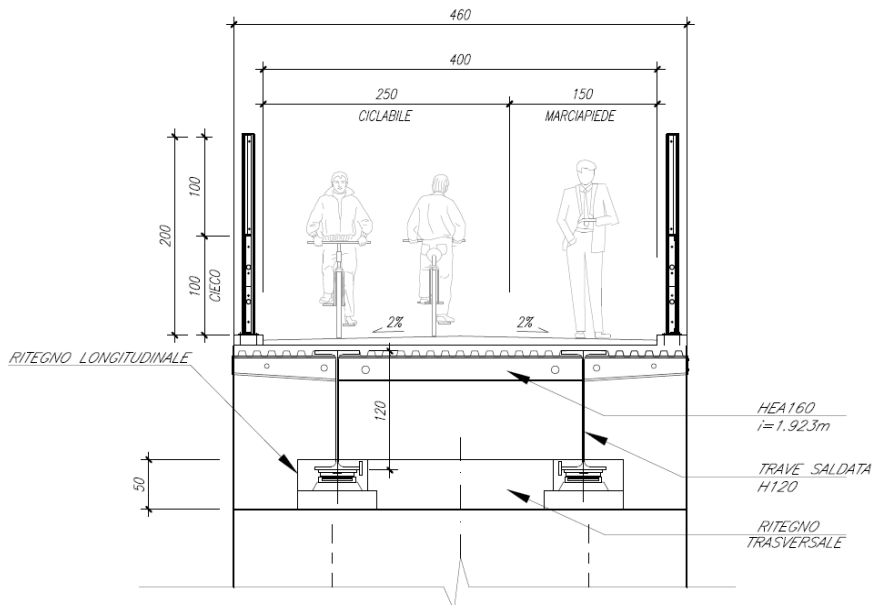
Sezione trasversale tipo dell'impalcato: sezione corrente
